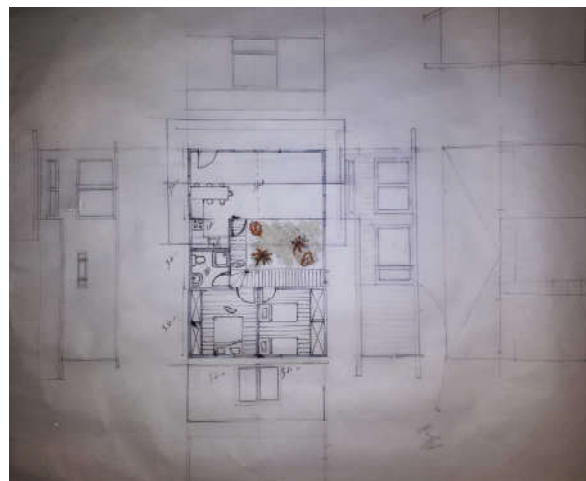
| Estudo de Fachada e Casa Pátio |
